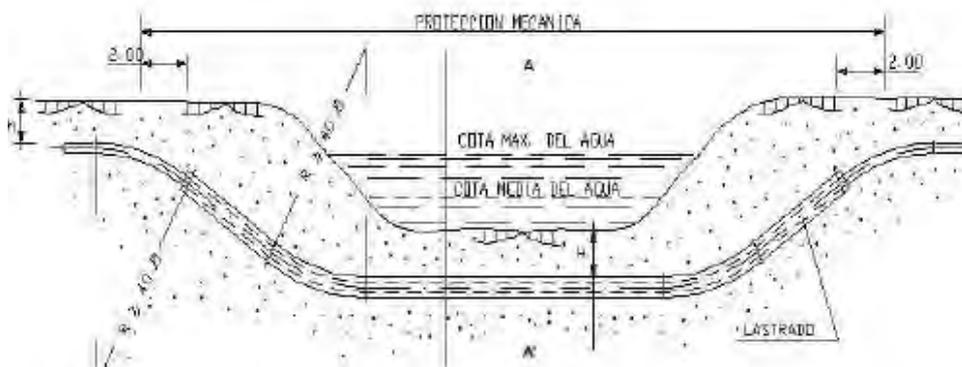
Croquis de cruce de arroyos mediante tubería lastrada (Fuente: documentación aportada)
